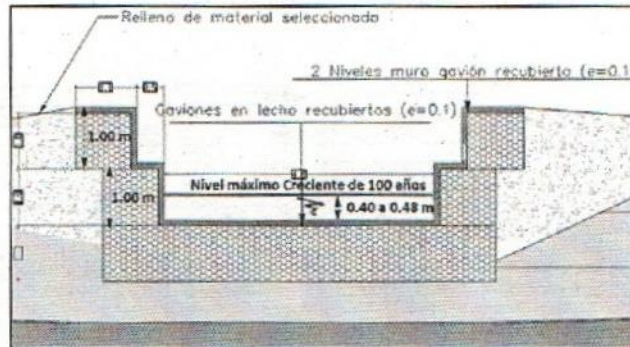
Sección transversal canalizada del arroyo Palinca, con el nivel máximo para la creyente máxima de 100 años de retorno. Tramo K0+053.34 a K0+029.19.
